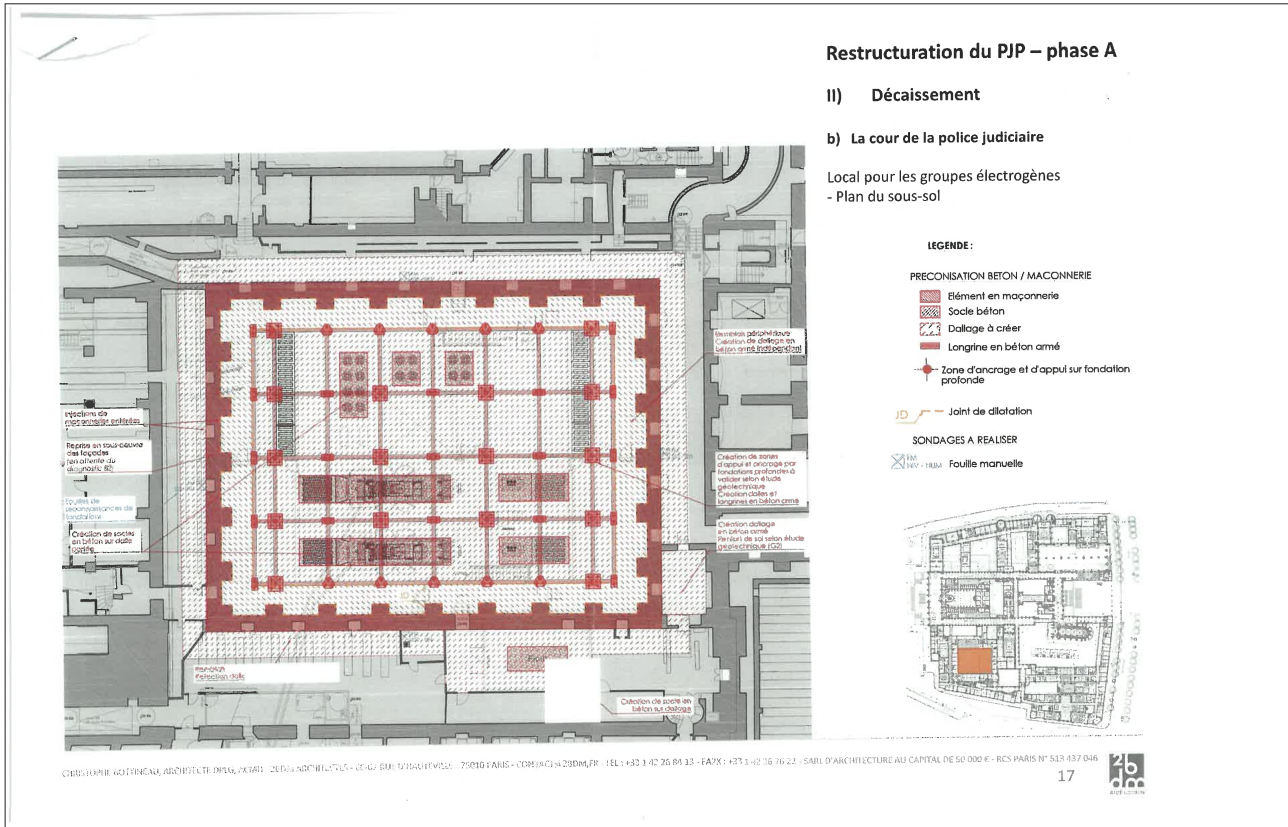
Plan du projet. Plan, Document 2BDM Architectes.
